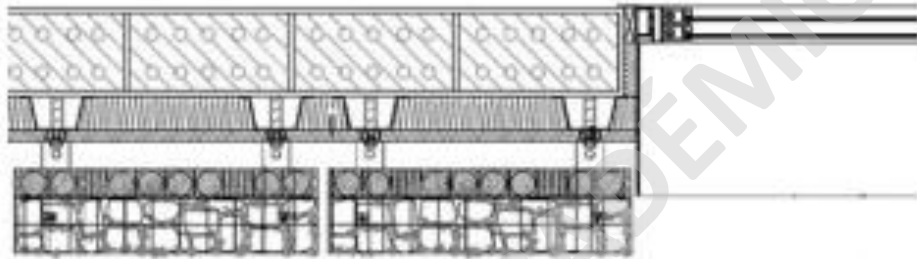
Corte horizontal sistema de paneles vegetados en cajas metálicas
